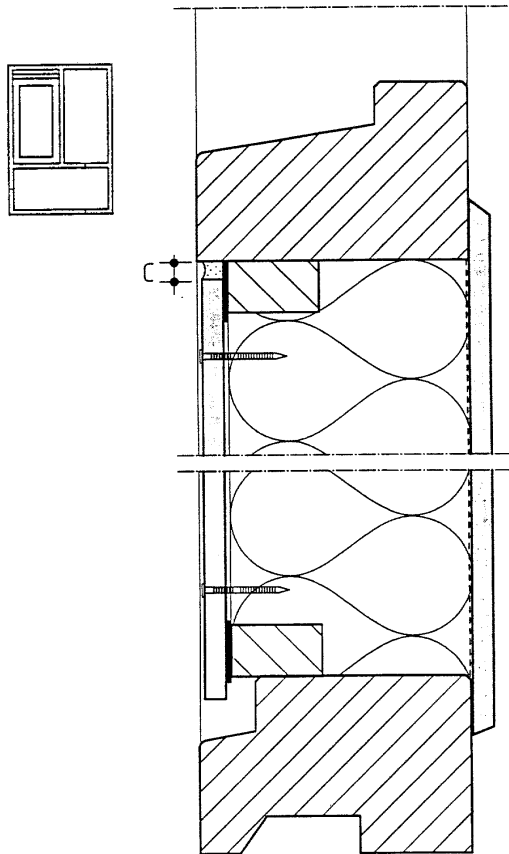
Coupe verticale d'une allège de châssis non-ventilée
